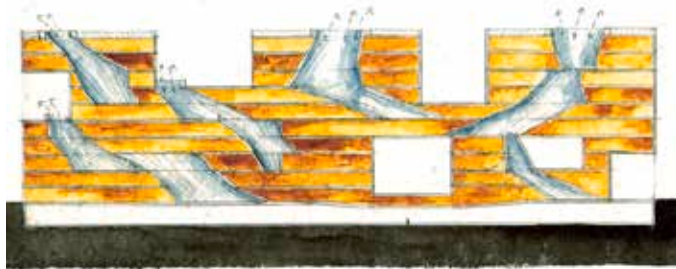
sección de Simmons hall *fuentes:* <https://www.archdaily.com/65172/simmons-hall-at-mit-steven-holl/stevenholl1> (2010)
